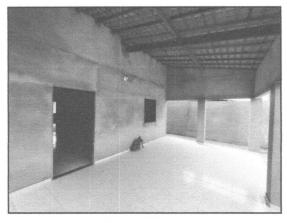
Imagem do Terraço, com destaque ao piso cerâmico
